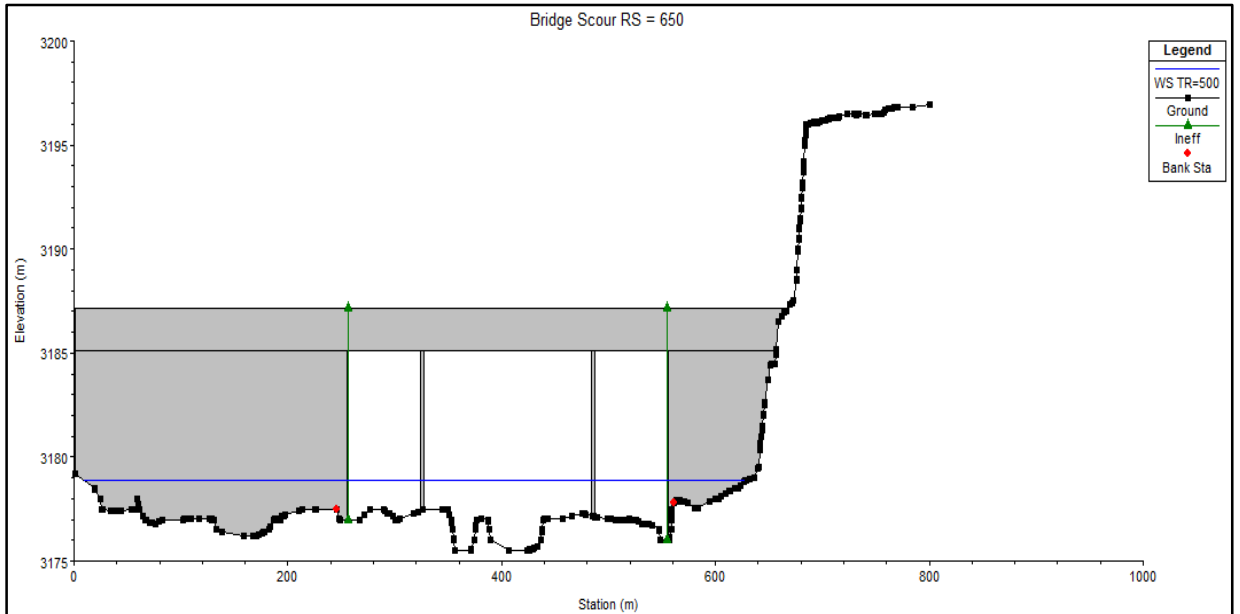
Sección transversal del cauce a la altura del puente donde se ve el detalle del pilar, los estribos y la superestructura. Tr=500 años
